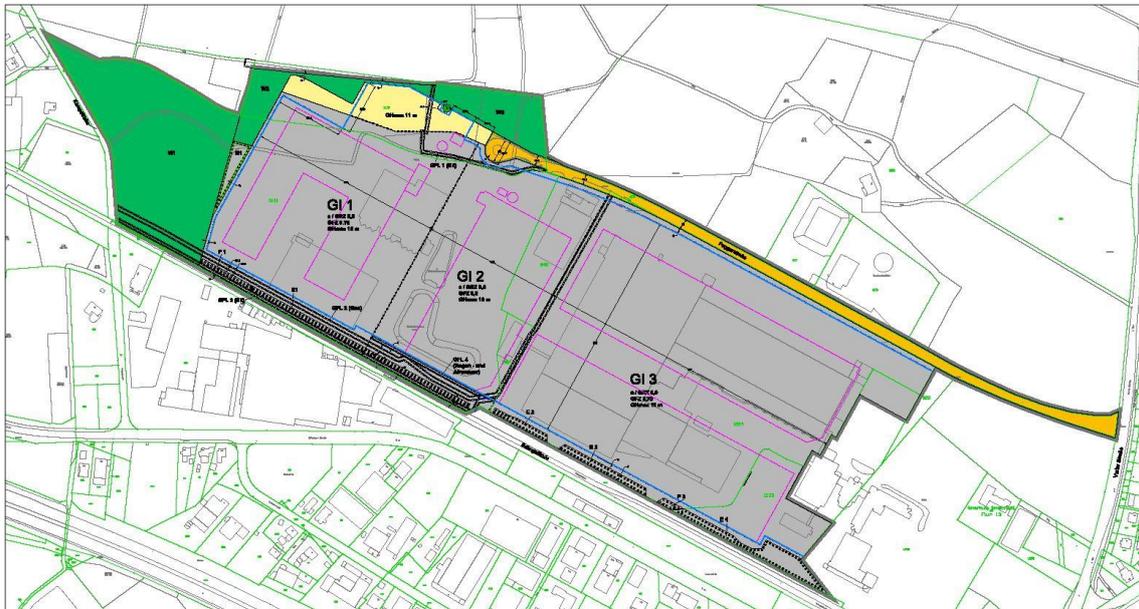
Bebauungsplan (©FIRU, Stand: 04.11.2015)
